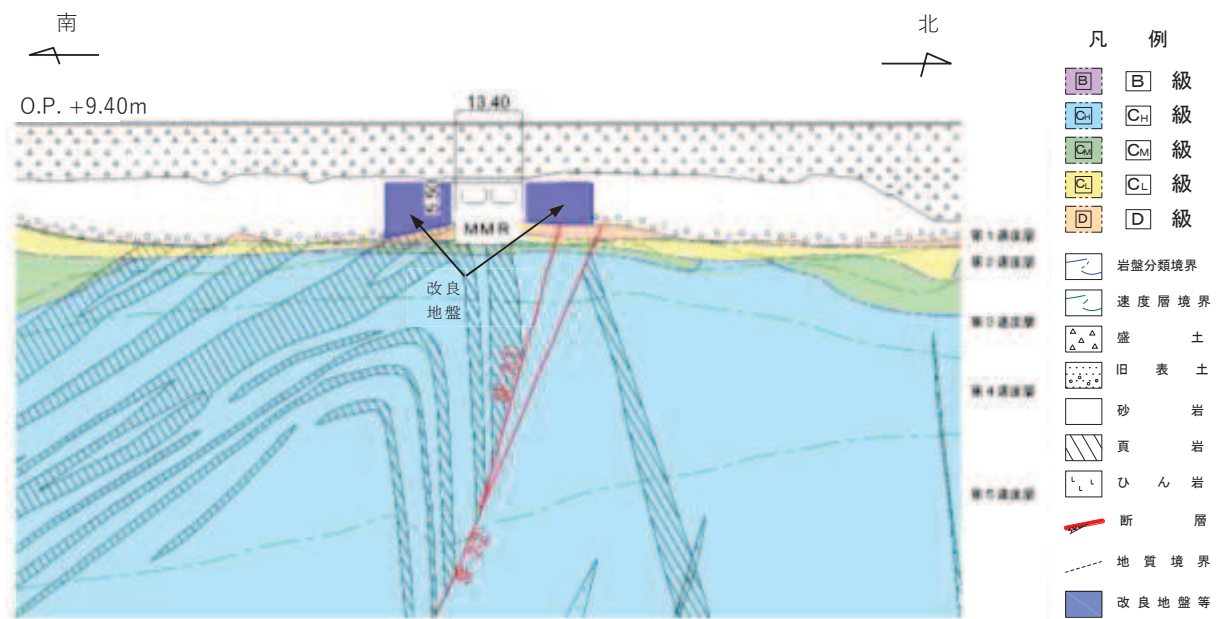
(2) 取水路の地質断面図 (㉔-㉔断面)
